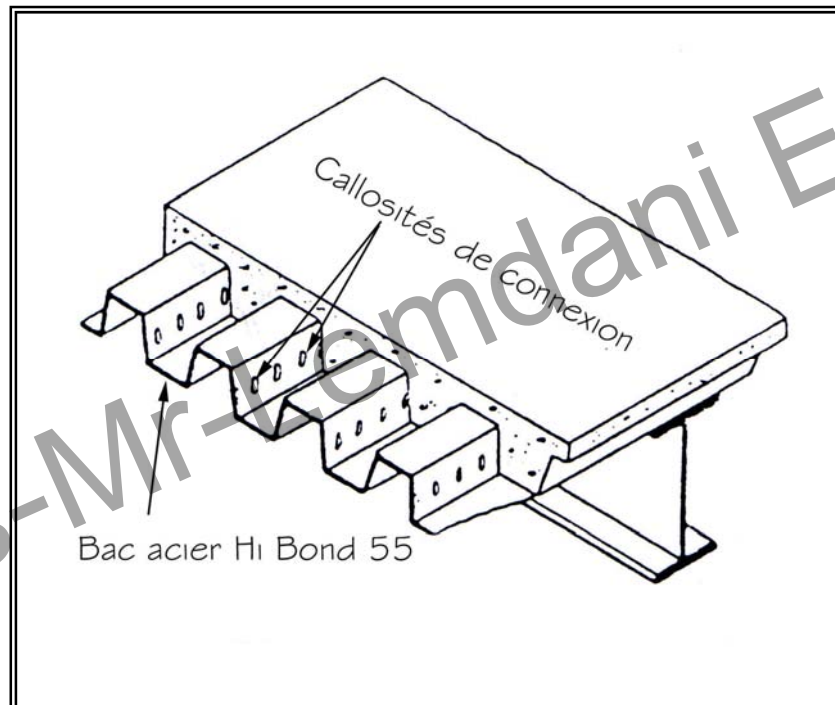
Plancher mixte collaborant avec dalles en béton armé sur
